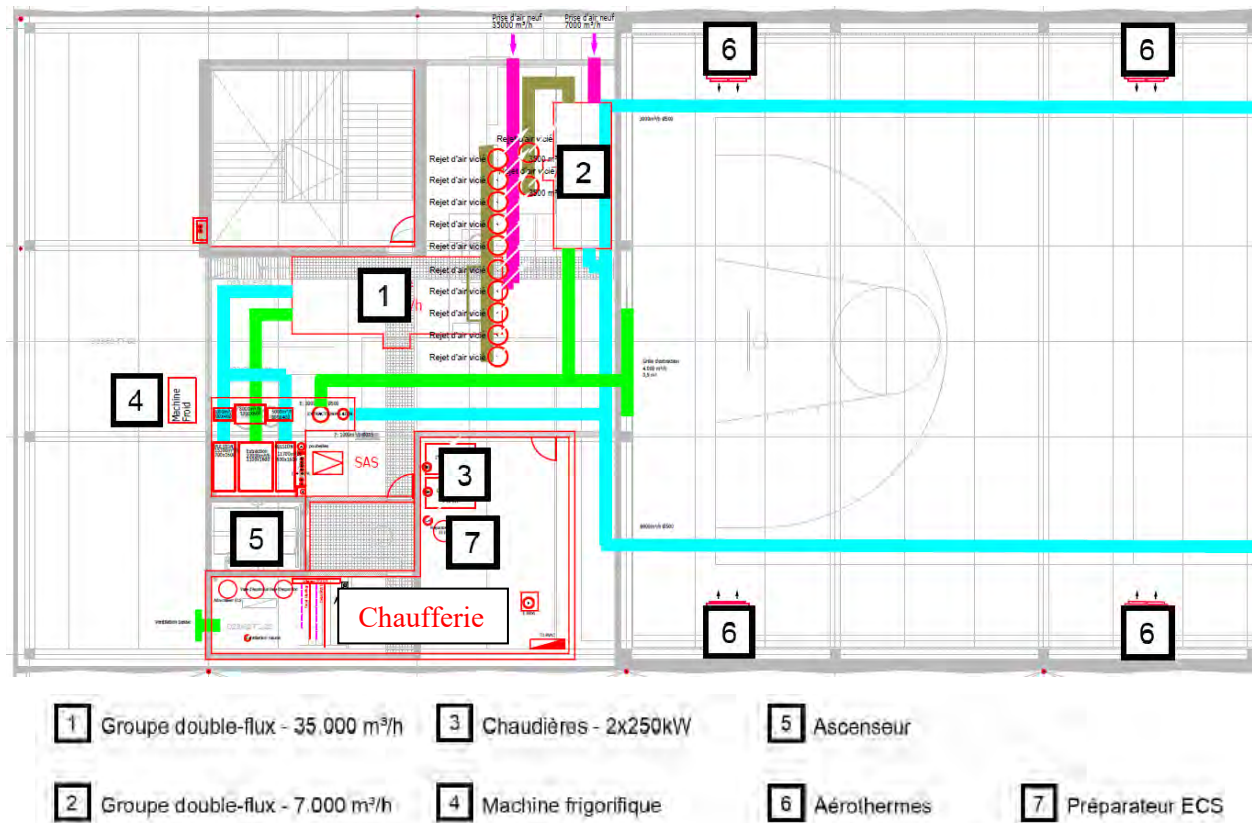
Localisation des installations techniques du bâtiment D2-3 sous-toiture (MK Engineering, 2018)
